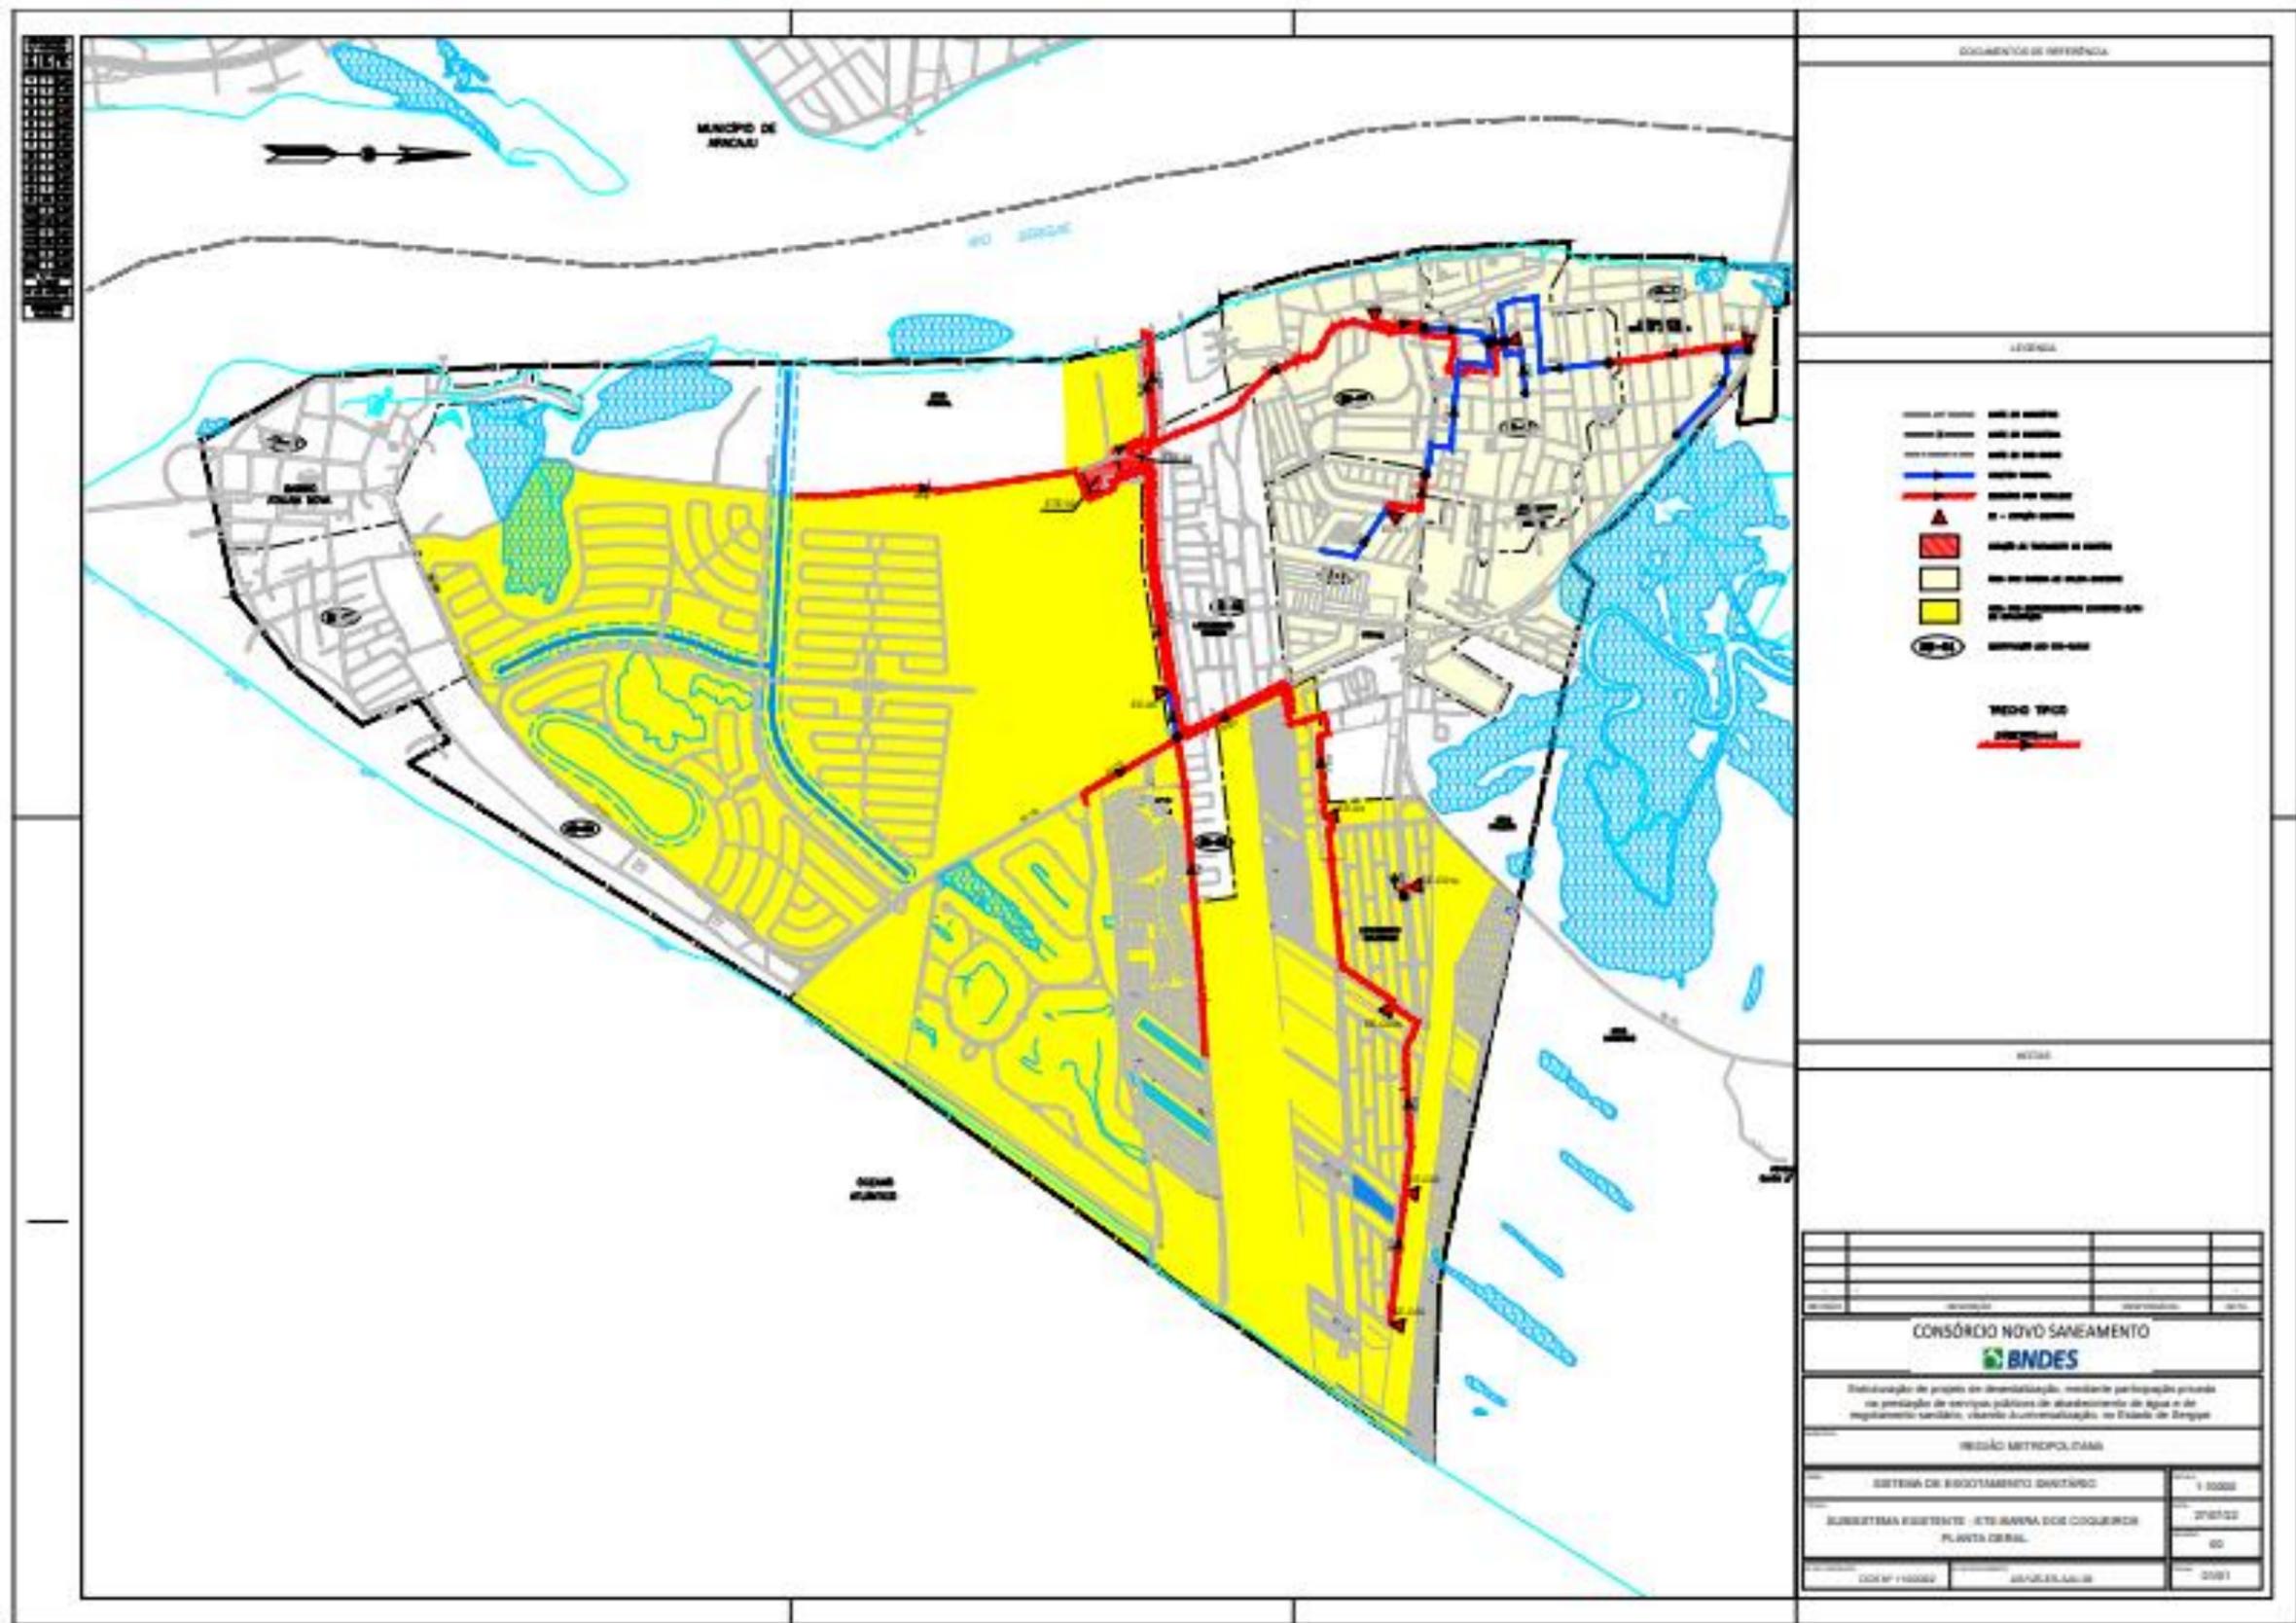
Planta do Sistema de Esgotamento Sanitário da Região Metropolitana – BARRA DOS COQUEIROS
